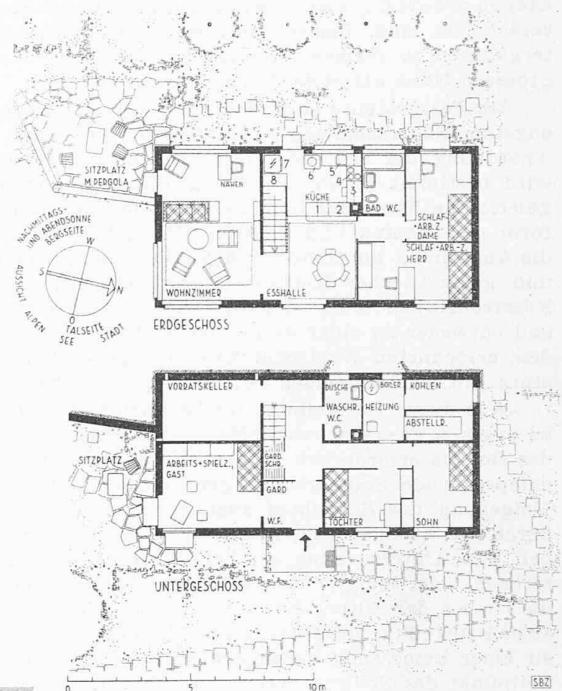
Grundrisse 1:300. Legende für Küche:
